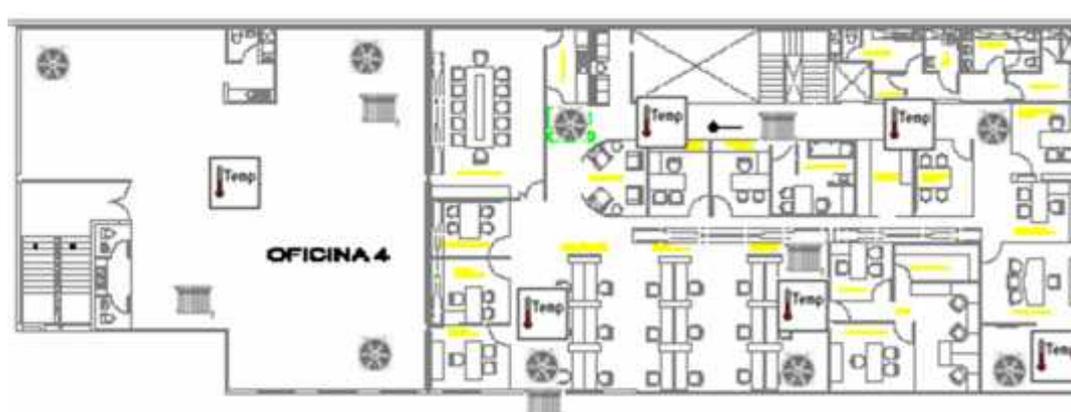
Subsistema de Calefacción y Ventilación en la Segunda Planta Alta del Área Comercial
